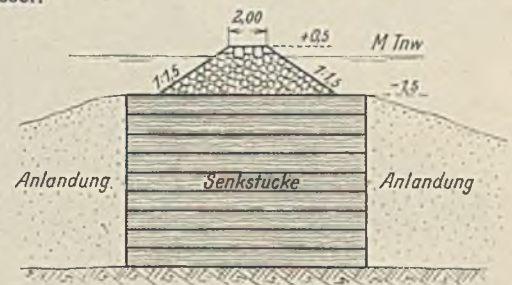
Querschnitt durch ein Stack. Endgültige Ausführung.
